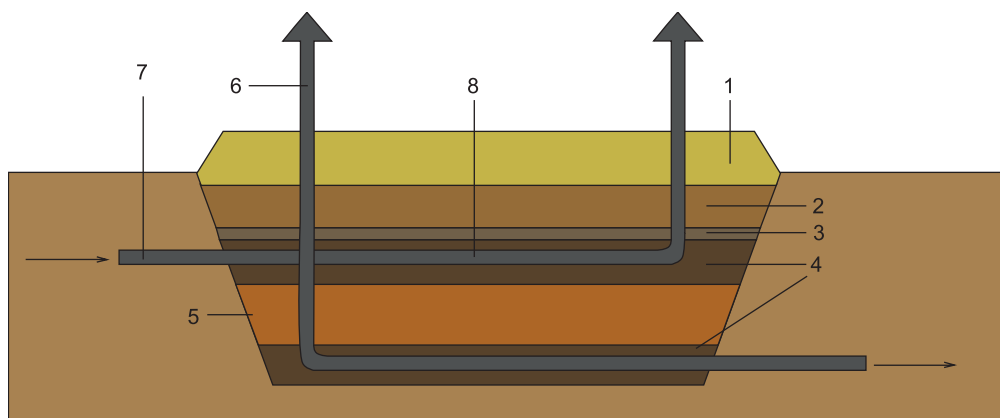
Устройство песчано-гравийных фильтров: 1 — утепляющая обсыпка; 2 — глиняный замок; 3 — гидроизоляция; 4 — зона орошения (щебень); 5 — песок; 6 — вентиляционный стояк; 7 — подводящий трубопровод; 8 — оросительные трубы
